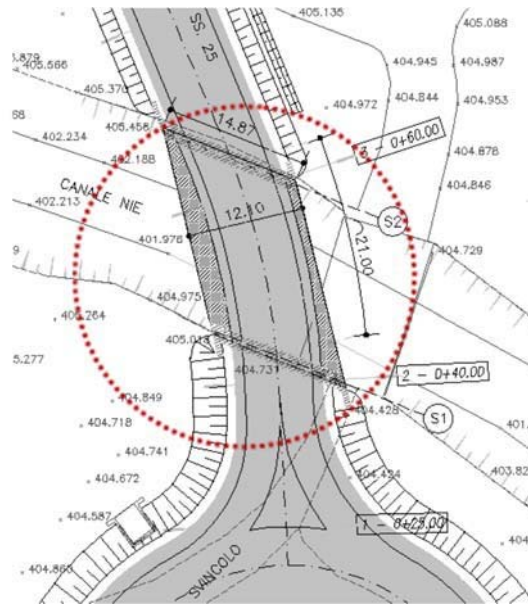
Profilo Ponte su canale NIEFigura 24 – Ubicazione planimetrica Ponte su canale NIE
